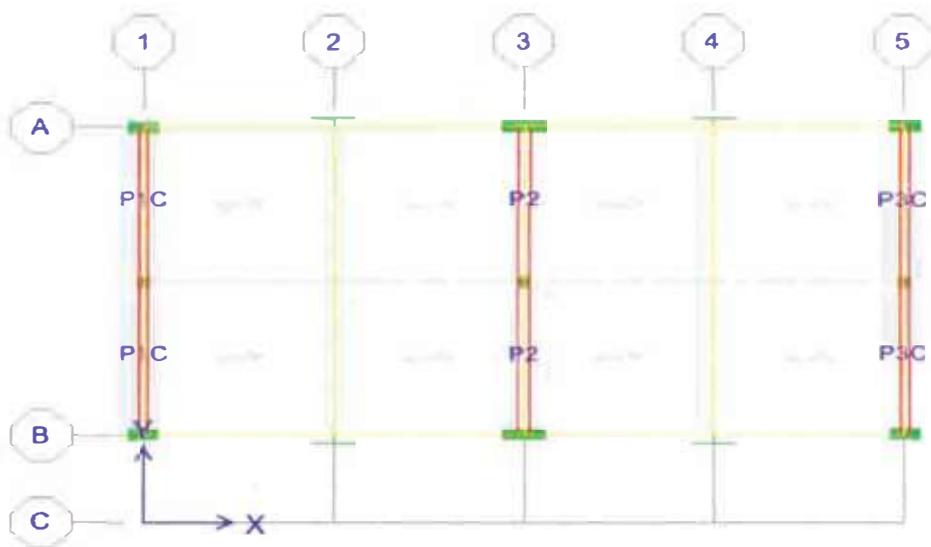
Vista en planta del Módulo 2A-3P con muros exteriores de concreto (P1C y P3C).
